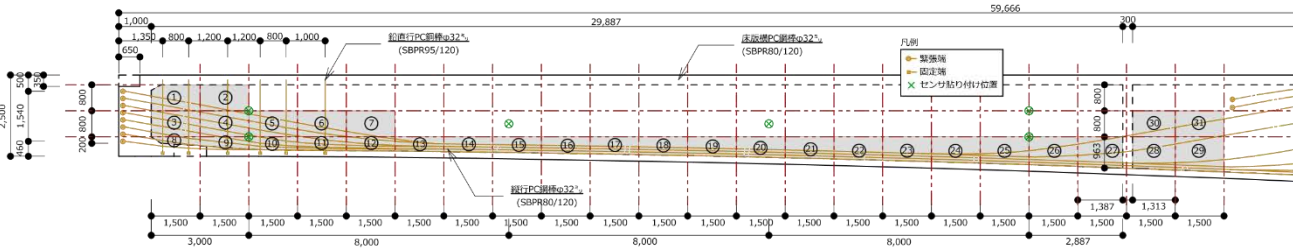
エリア分け及びセンサ配置位置を示した西側側面図
